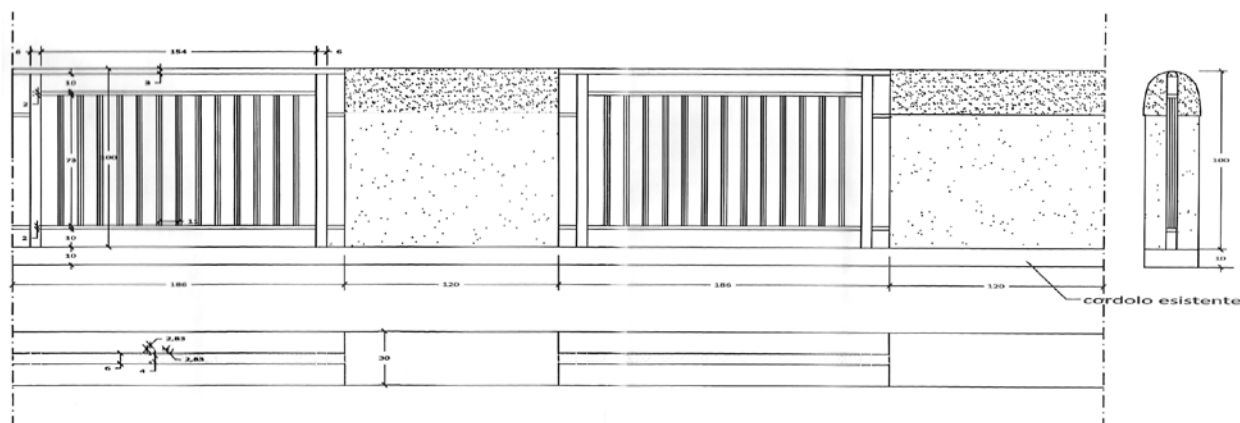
barriera di protezione stradale sostitutiva “TIPO” prevista (prospetto/pianta/sezione)
